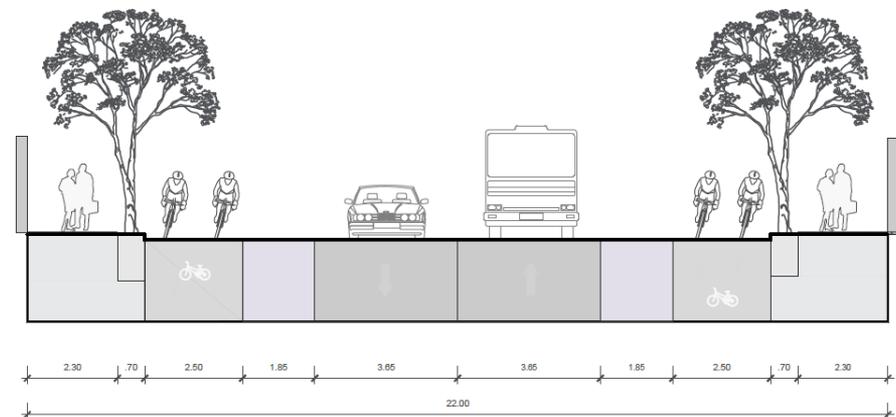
Perfil vial proyectado de la avenida Paisajística del Tunjuelo.. Fuente: Elaboración propia con base en la resolución 448 de 2007.
